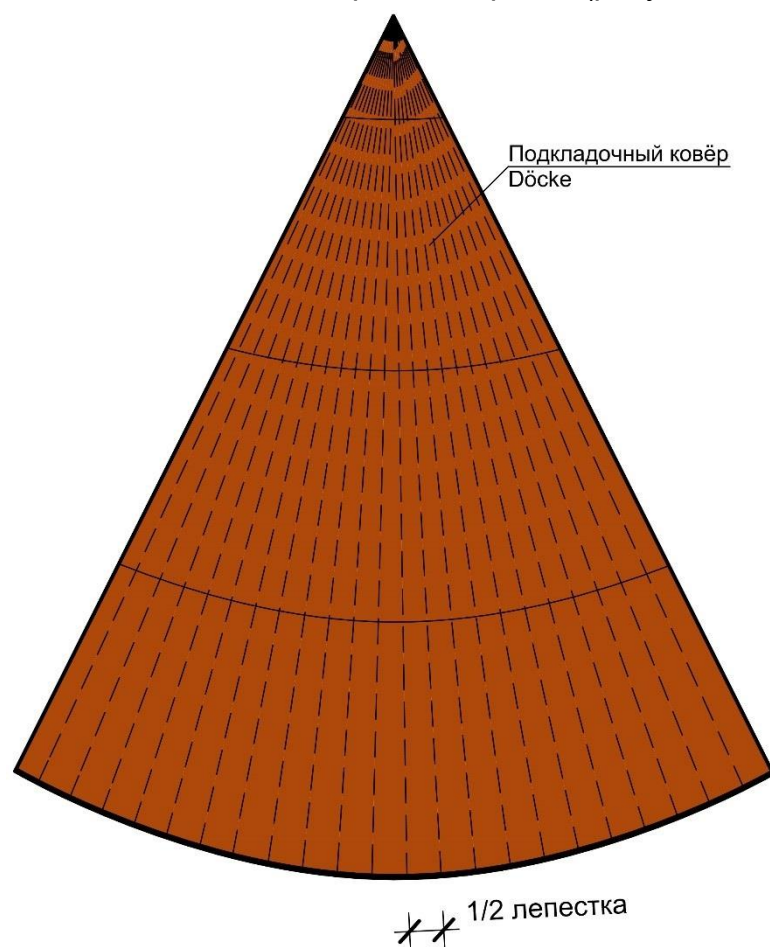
Разметка скатов конических и купольных крыш
